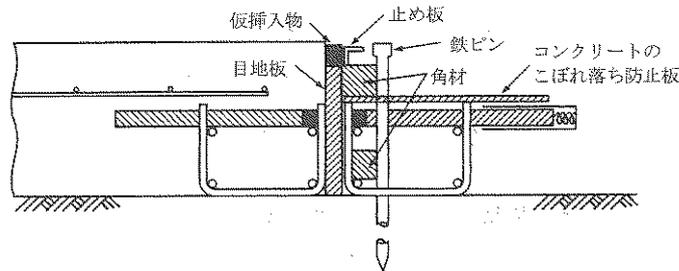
1日の舗設の終わりに設ける横膨張目地の施工例⁵⁾
